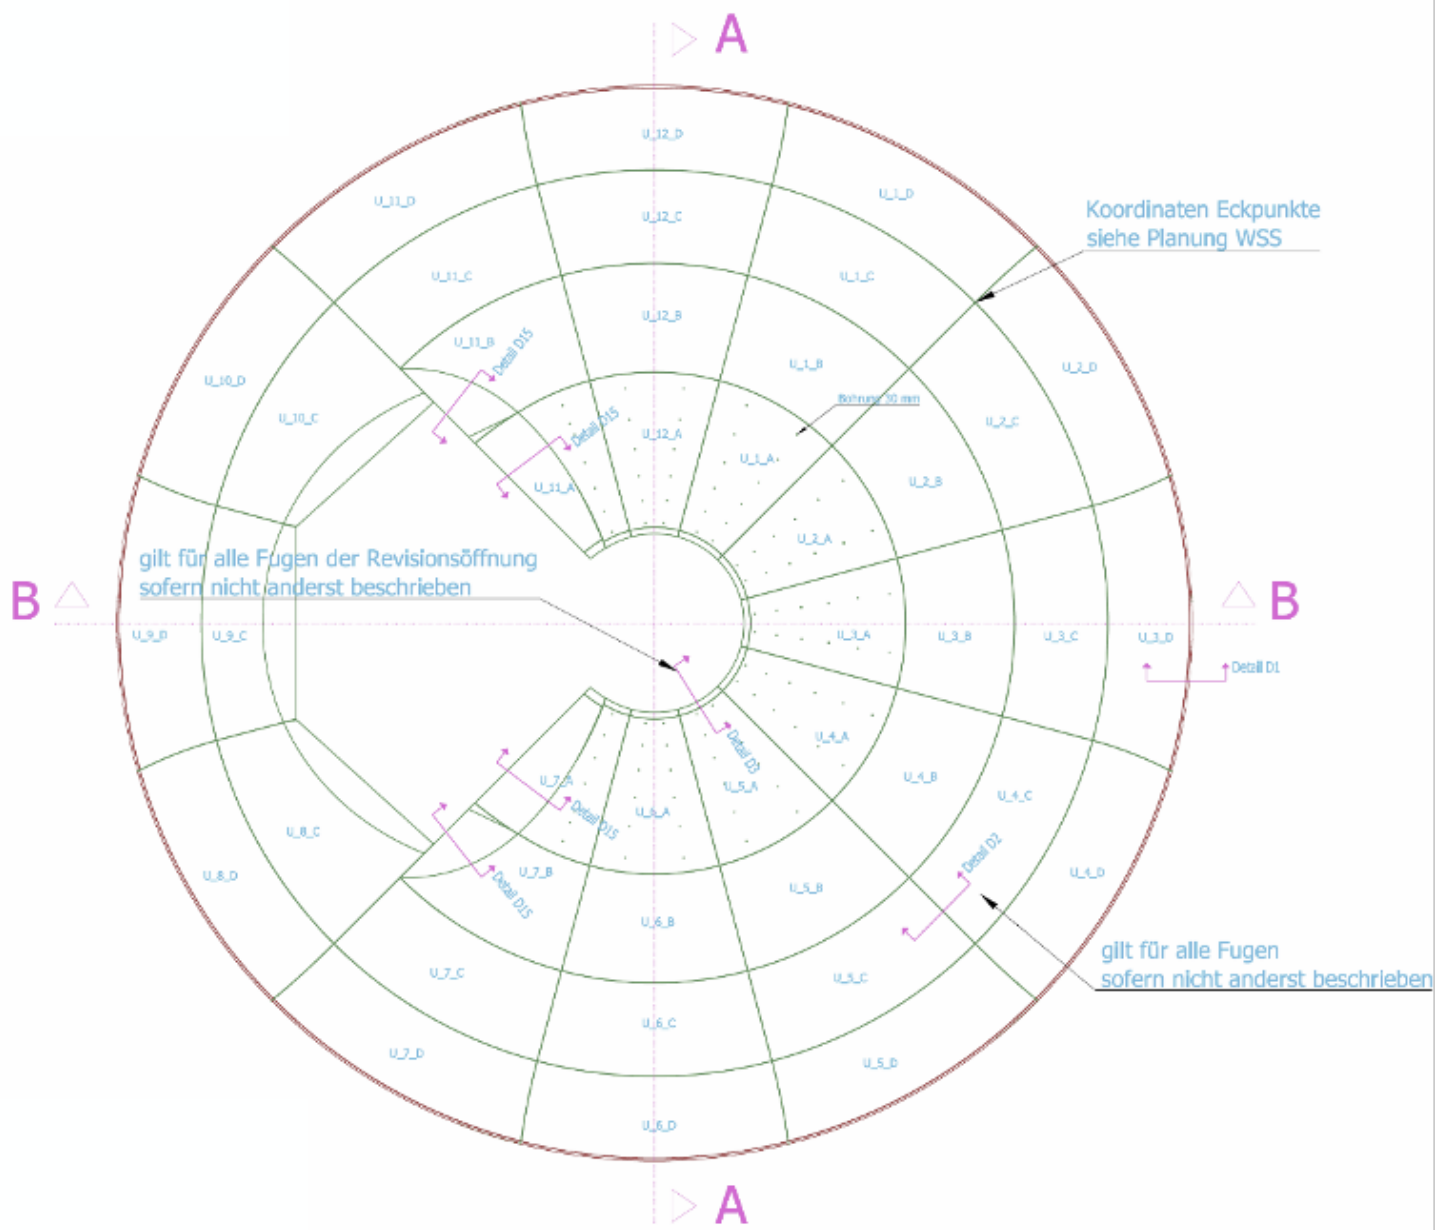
Regelkelchgeometrie – Draufsicht [16]
